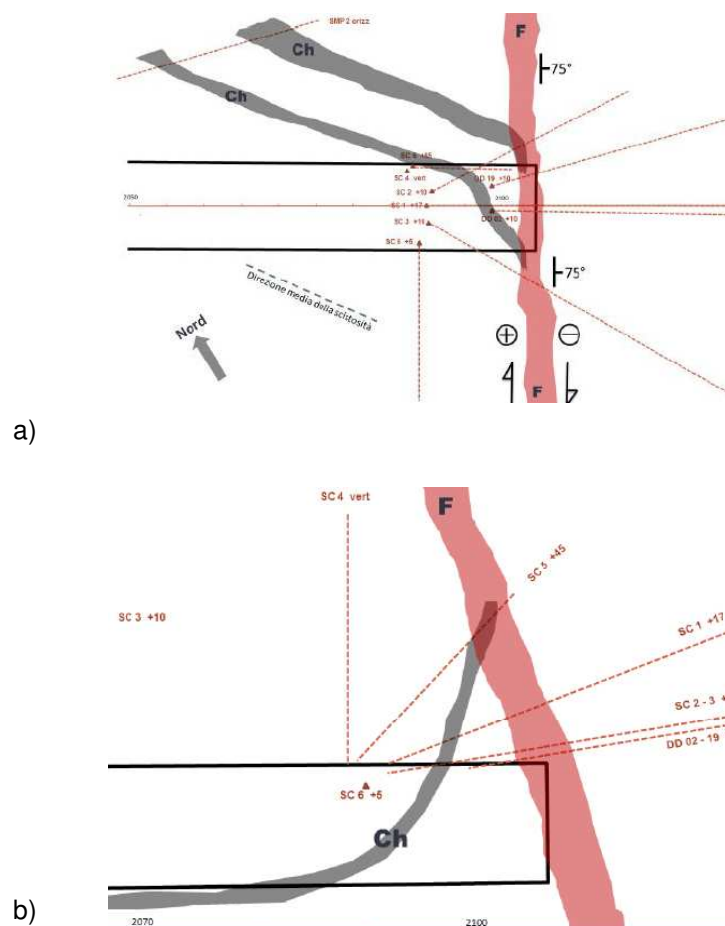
Faille principale Pk 12+100 (F : faille ; Ch : couches de charbon) – a) Vue en plan - b) Coupe longitudinale
